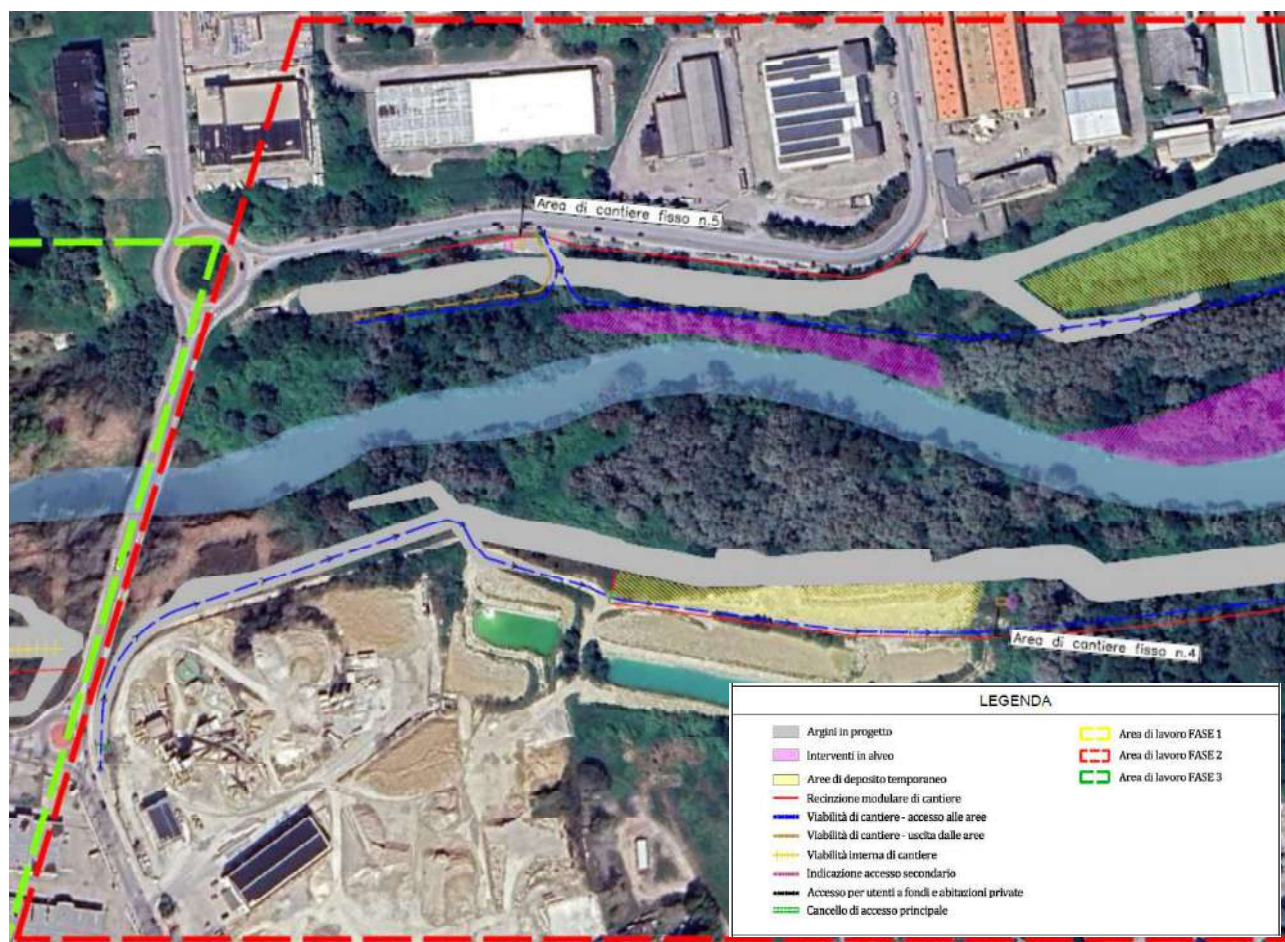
Cantierizzazione - Fase 2 (tratto di monte)
